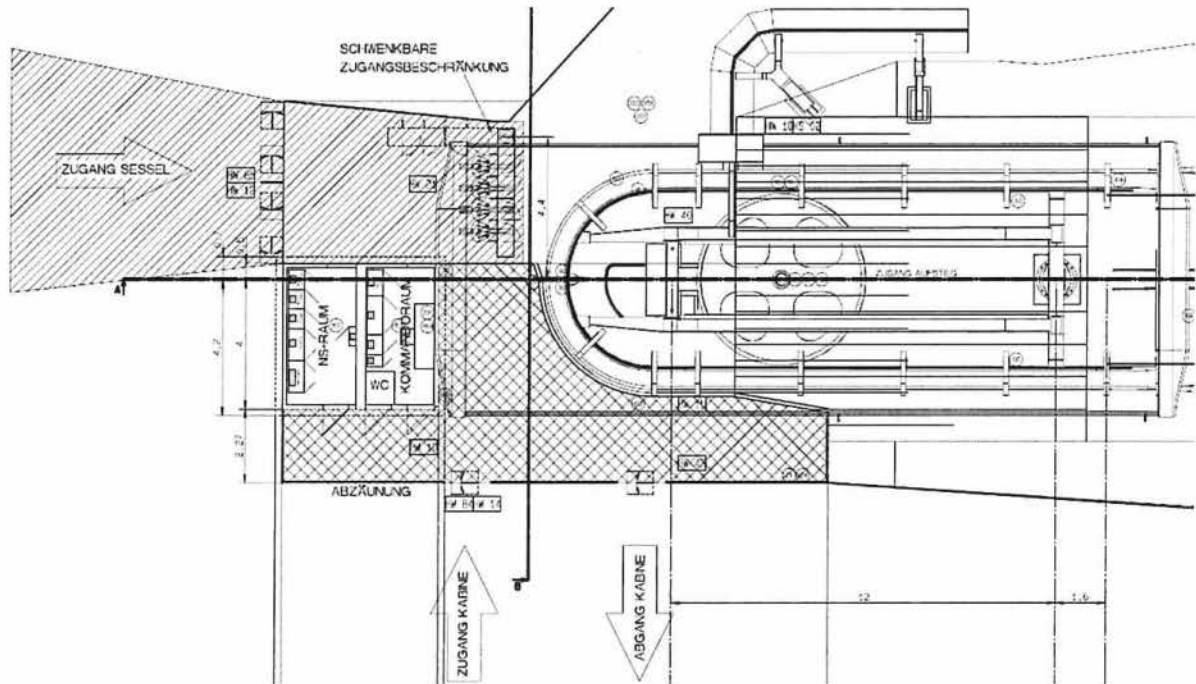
Grundrissplan Kombibahn mit Kabinen/Sesselzugang
